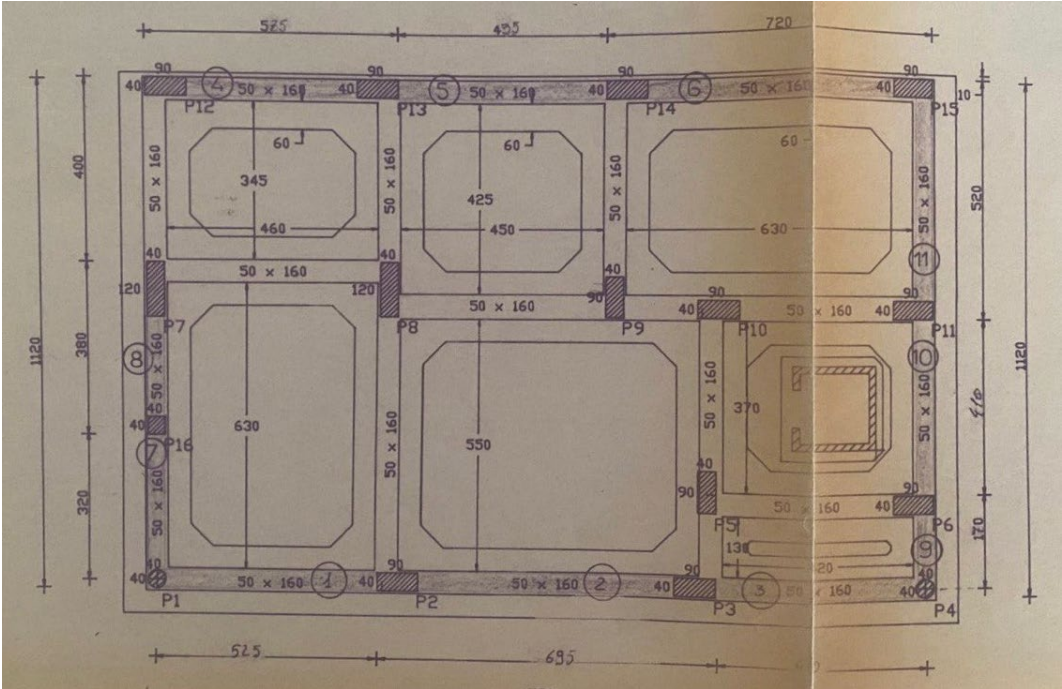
Carpenzeria fondazioni edificio oggetto di studio
